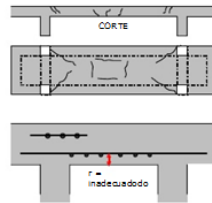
Helene, P. (2003). Manual de rehabilitación de estructuras de hormigón [Figura]. Recuperado de <https://es.scribd.com/doc/35762562/Manual-Rehabilitacion-de-Estructuras-Hormigon-Reparacion-Refuerzo>
